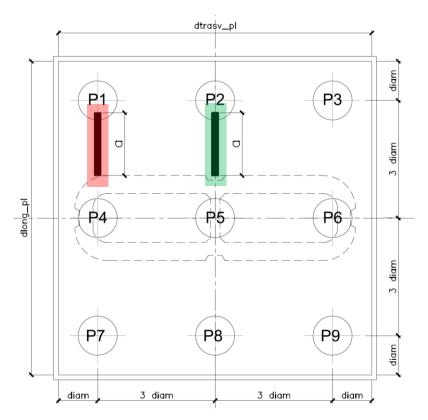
Vista in pianta - Tirante-puntone centrale (verde) e di spigolo (rosso)
